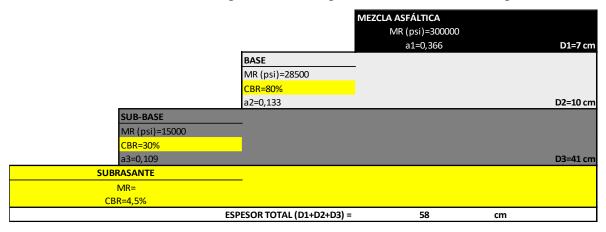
Diseño de pavimento sin estabilizar la subrasante natural.
